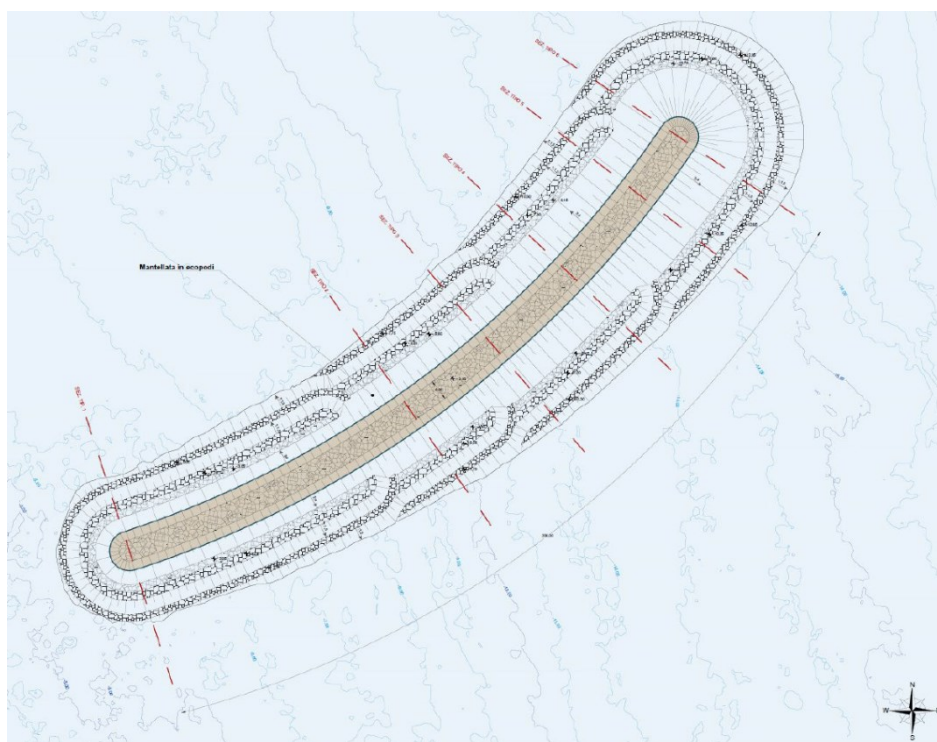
Stralcio planimetria scogliera di protezione dalle onde del II quadrante
